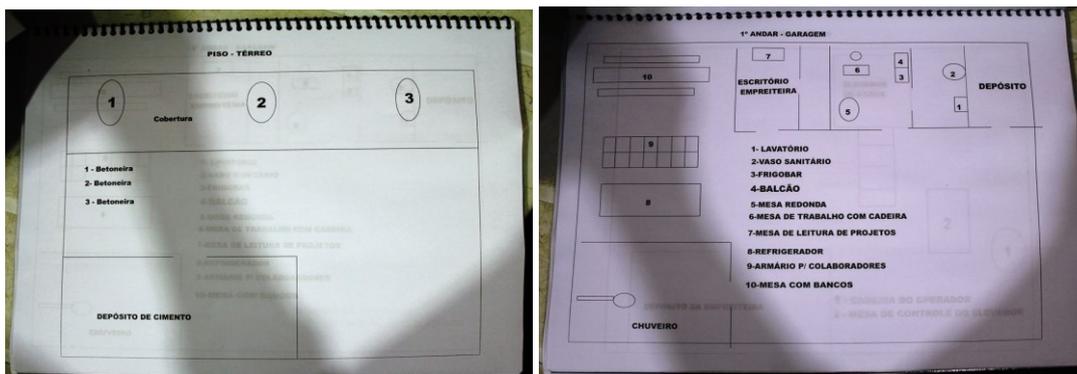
Layout do canteiro pelo PCMAT da OBRA C
